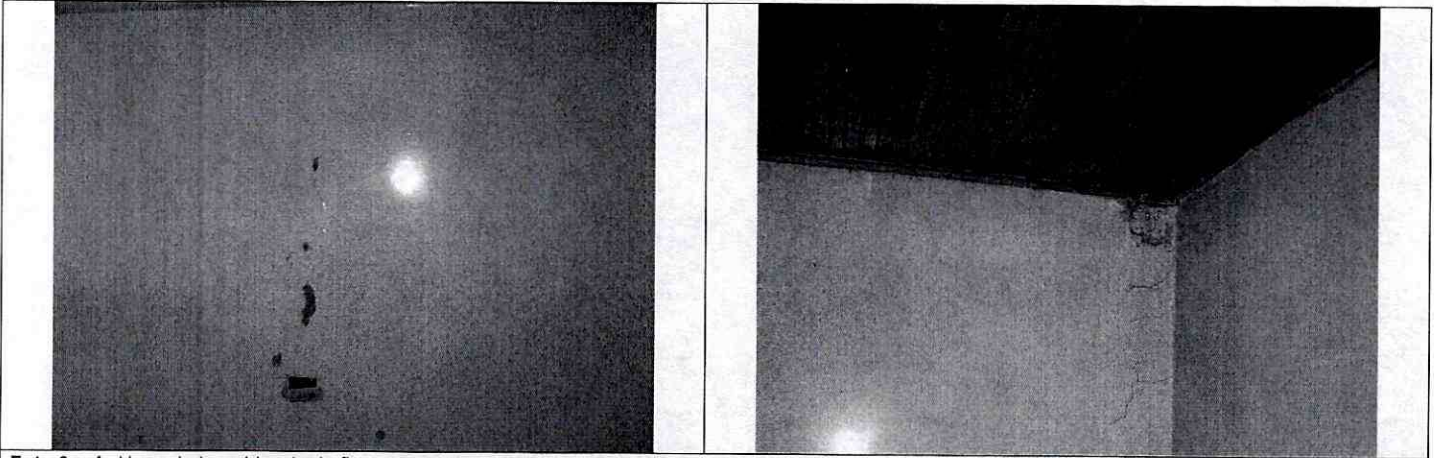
y 4. Humedad y evidencia de fisuras menores en muro posterior de primer piso en la vivienda de la Transversal 52C # 1-70.
